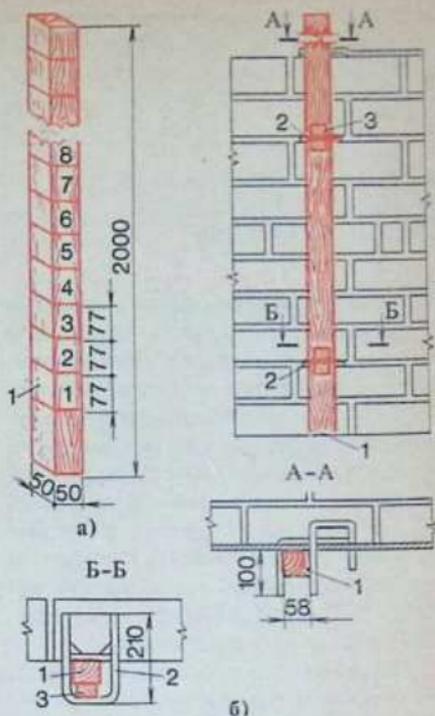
Инвентарная деревянная порядовка (а) и крепление порядовки к кладке (б): 1 — рейка, 2 — держатель, 3 — клин
